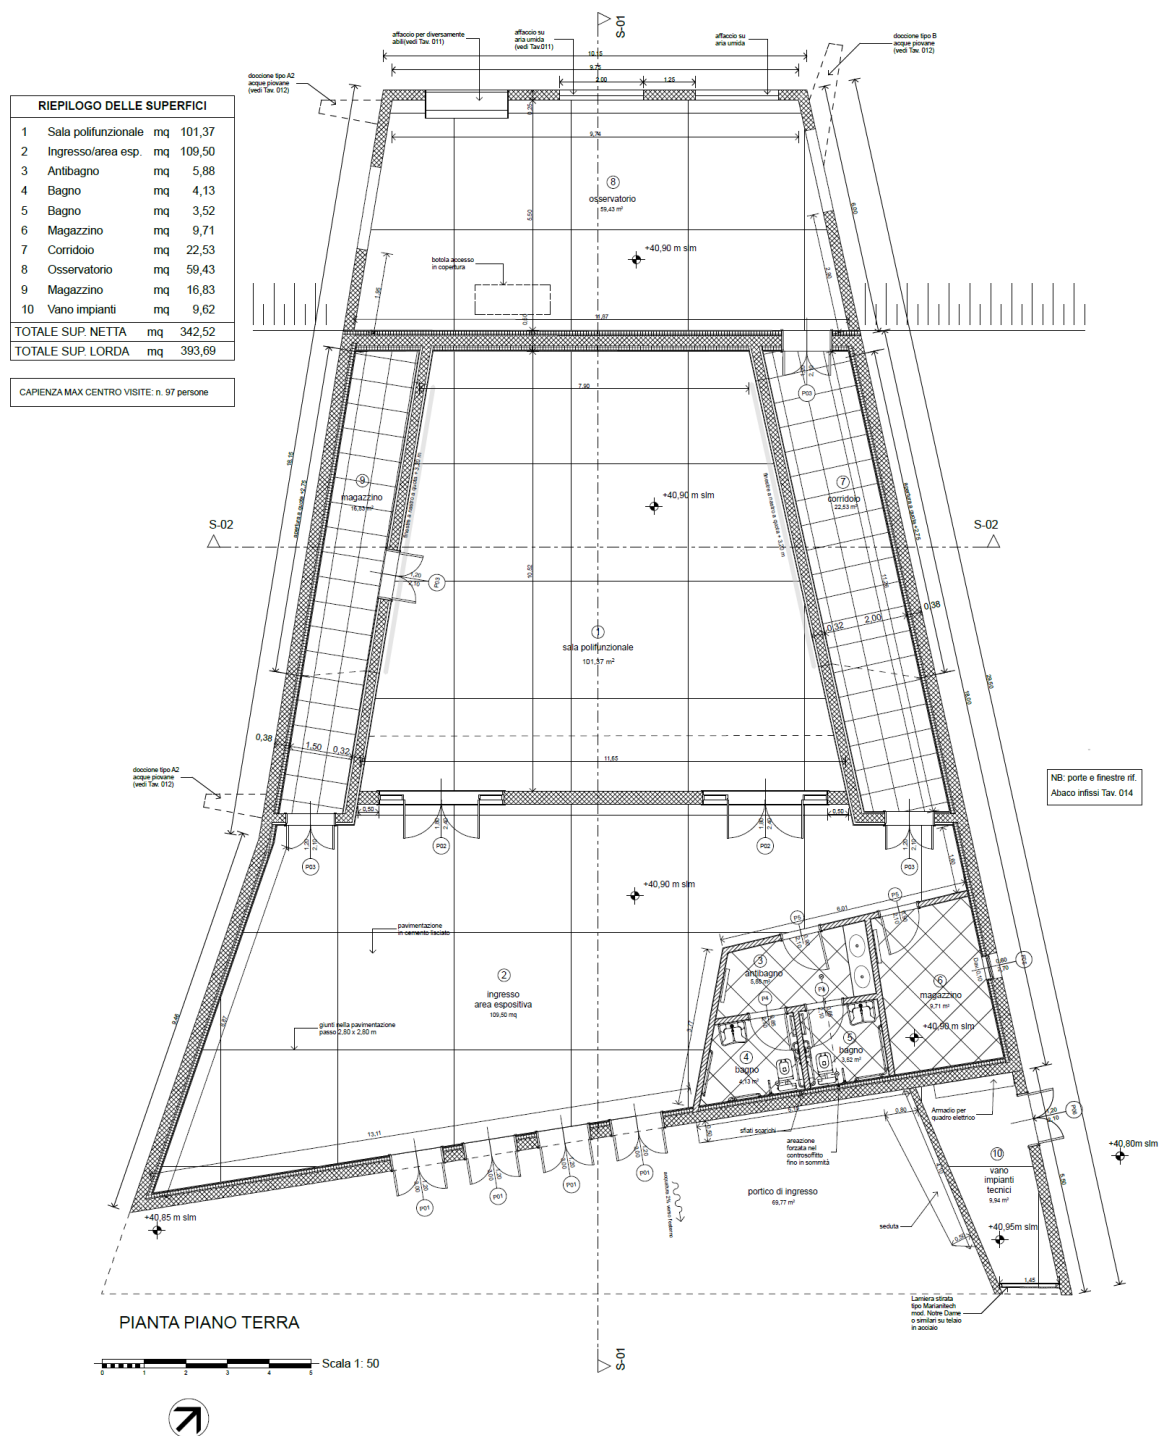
Pianta dei locali del Centro Visite (estratto el. FLR-MPL-PSA-CAP4-023-AR-PL_Manetti CV Plan)
